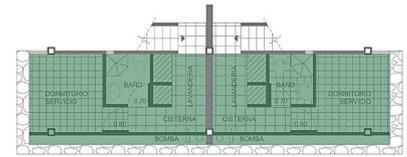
Zonificación en Planta Baja. Azul: Zona privada; Amarillo: Zona de Transición; Naranja: zona social; Verde: Zona de servicio.
